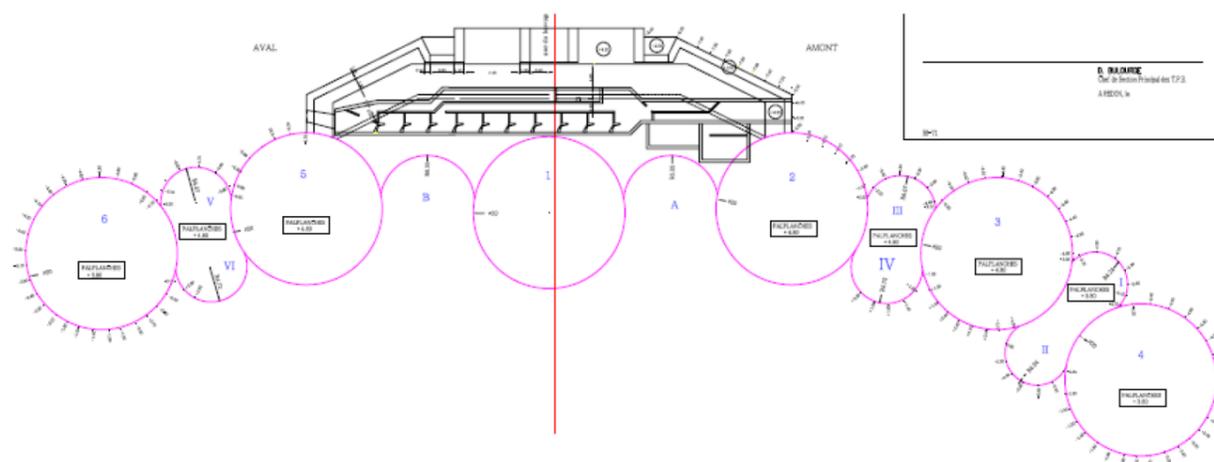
Plan des gabions du barrage d'Arzal – Source : EPTB Vilaine
